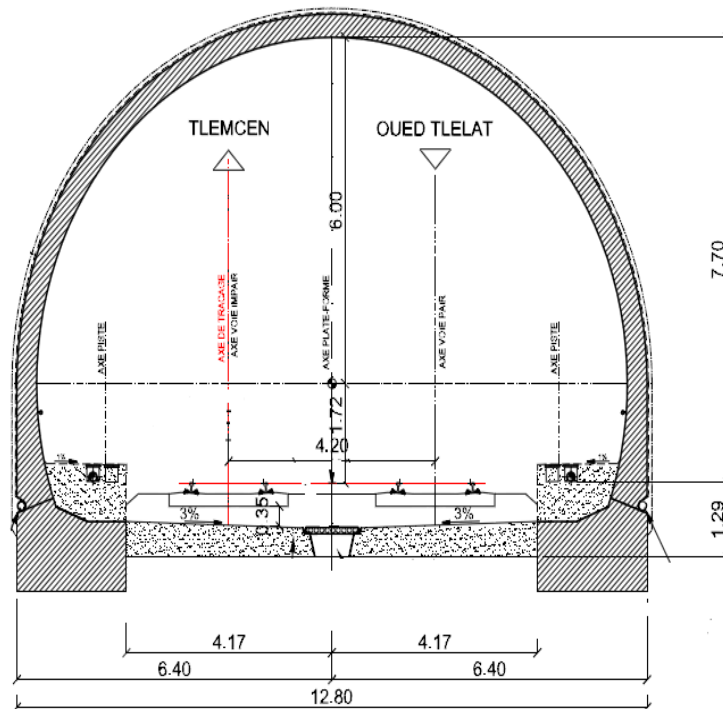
section courante tunnel 'OUED TLELAT/TLEMCEN'
